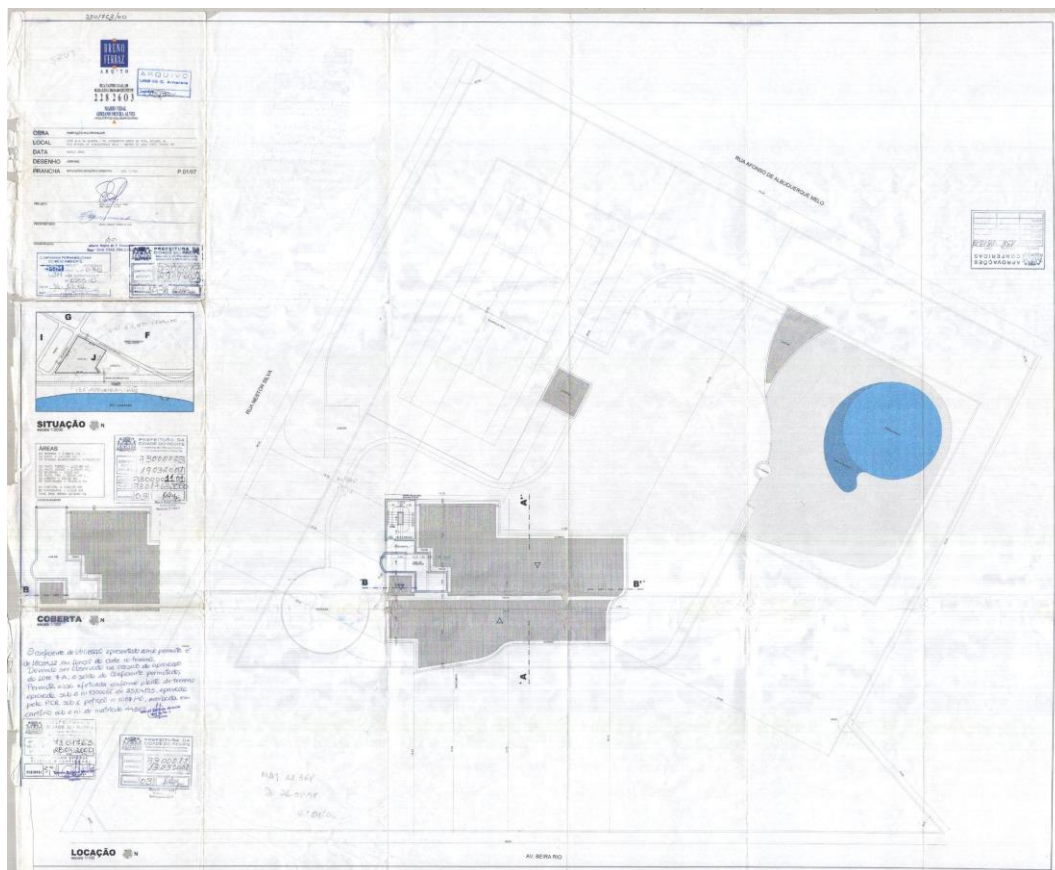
Planta de localização do Edif. Terra Brasilis, do arquiteto Bruno Ferraz, 2005.
